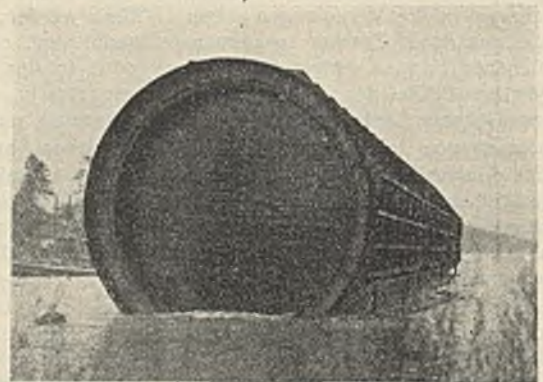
Die Röhre ist in der Werkstätte fertiggestellt. Innen- und Kielbeton eingebracht und die Schalung für den äußeren Beton ist fertig. Röhre ist im Dock verankert und bereit, nach der Einbaustelle abgeschwommen zu werden.
